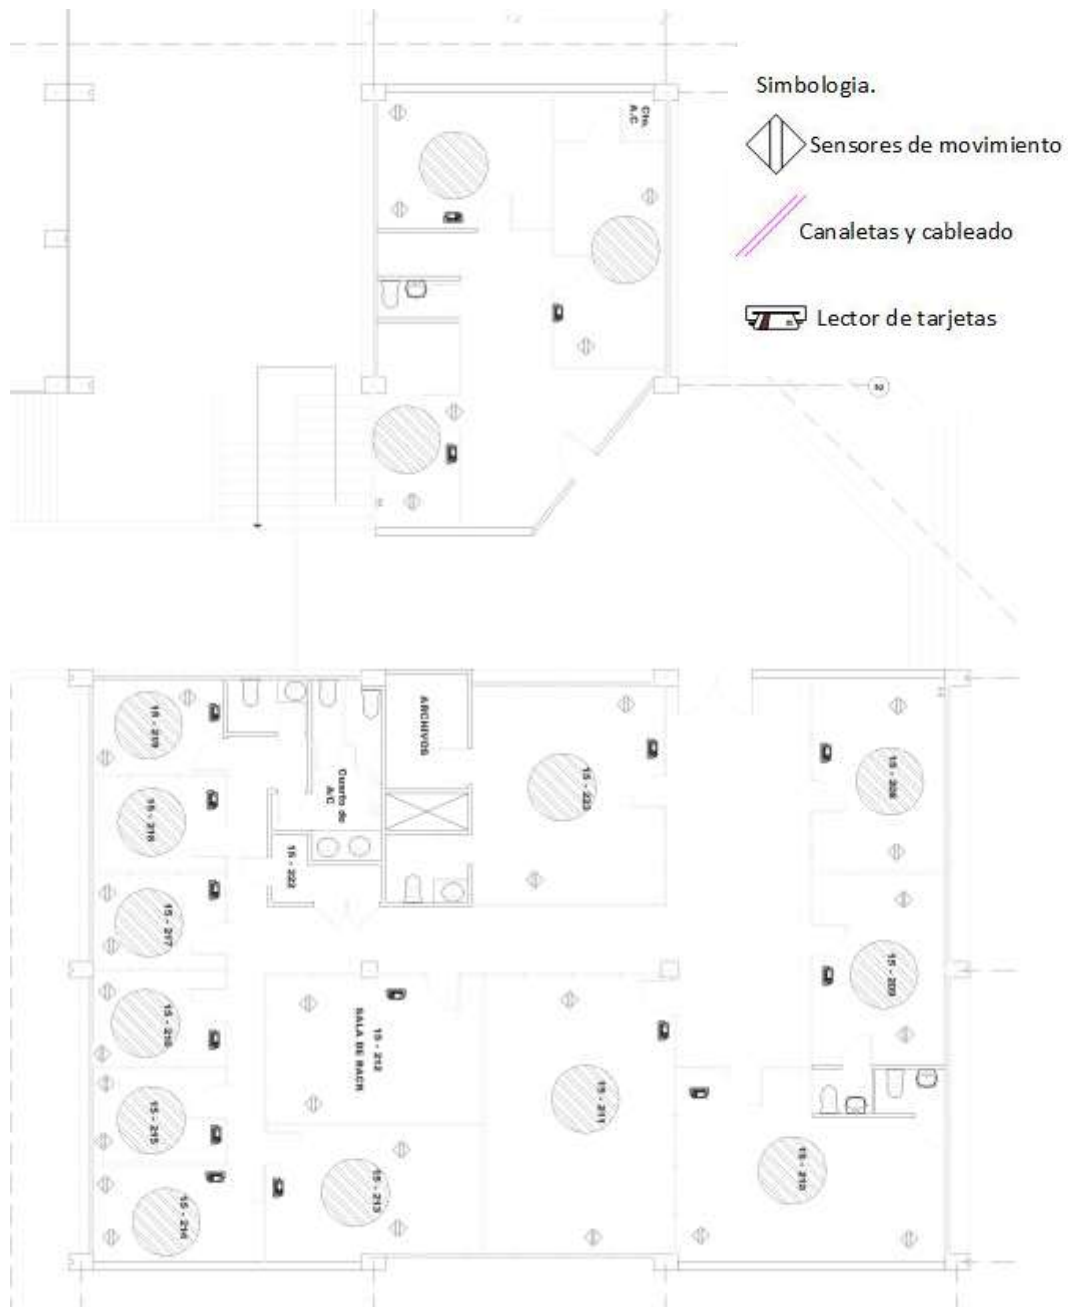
Diseño Estructural del Sistema del bloque 15A Grupo Cisco planta alta
